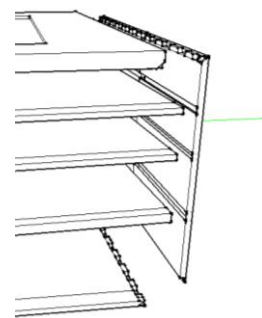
Pormenor da ligação entre os entrepanos e as faces dos painéis da estrutura da fábrica. Fonte: el. pr.
